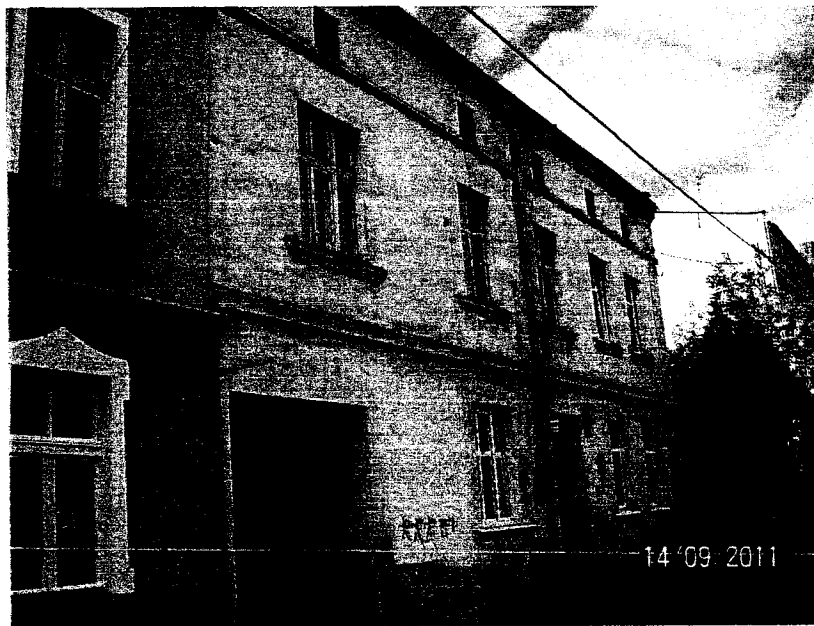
Budynek frontowy - elewacja północna (frontowa)
